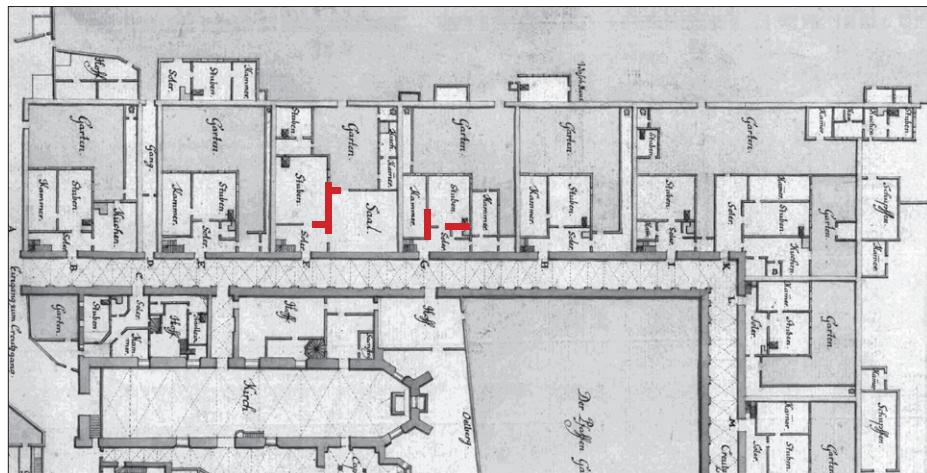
Ältester erhaltener Grundrissplan der Nürnberger Kartause von 1760 (Ausschnitt) mit Markierung der in den Mönchshäusern detektierten Mauerreste. Plan: Stadtarchiv Nürnberg, A 4/l Nr. 58; Bearbeitung: R. Linck.
